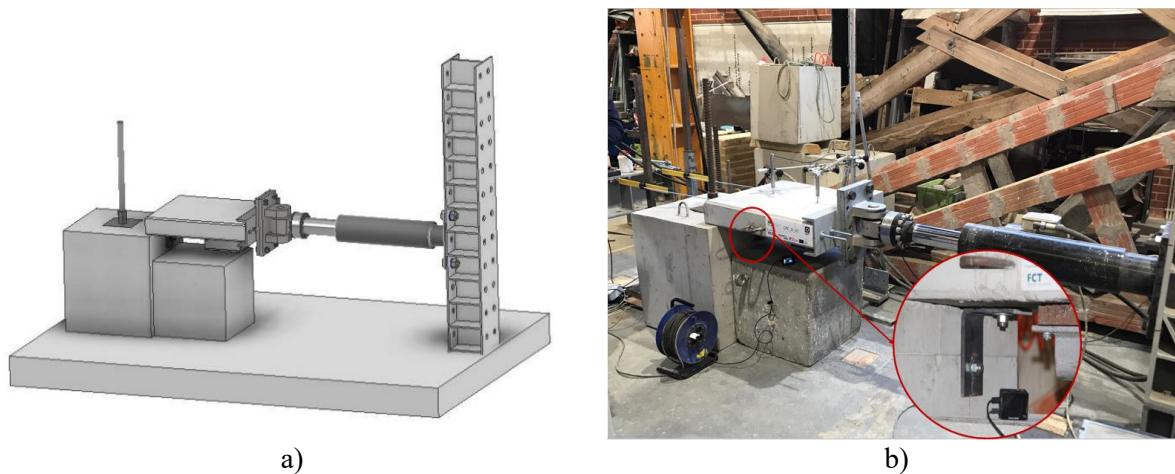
Setup de ensaio de ligações painel-pilar; a) Esquema de ensaio; b) Vista geral.
